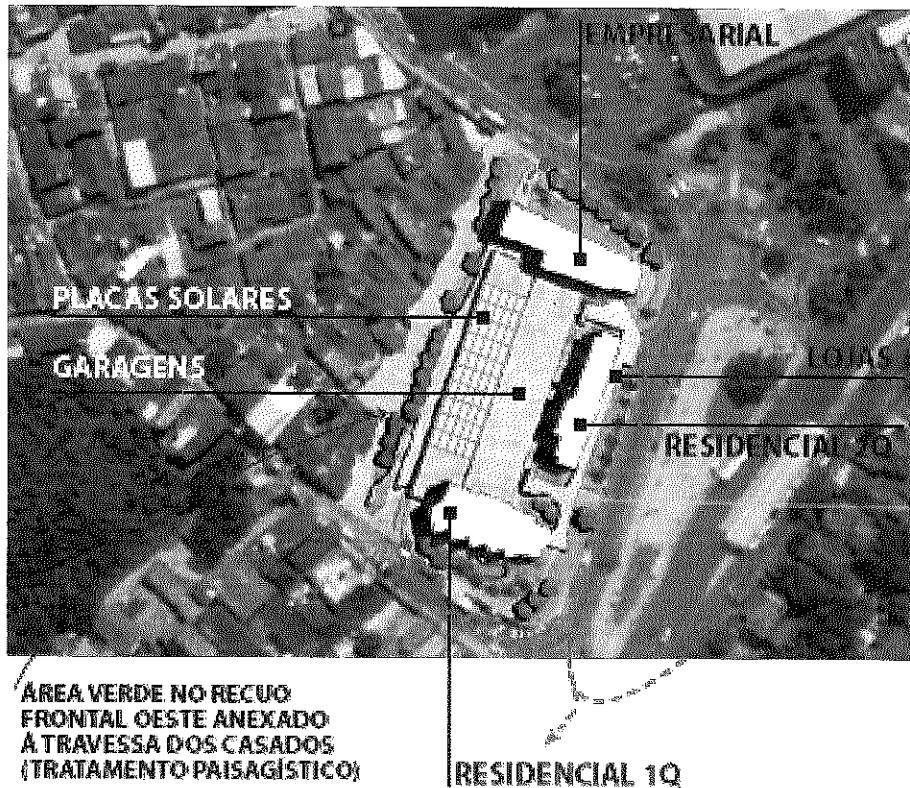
esquema da implantação da nova proposta para o empreendimento. Fonte: Autor do Projeto
